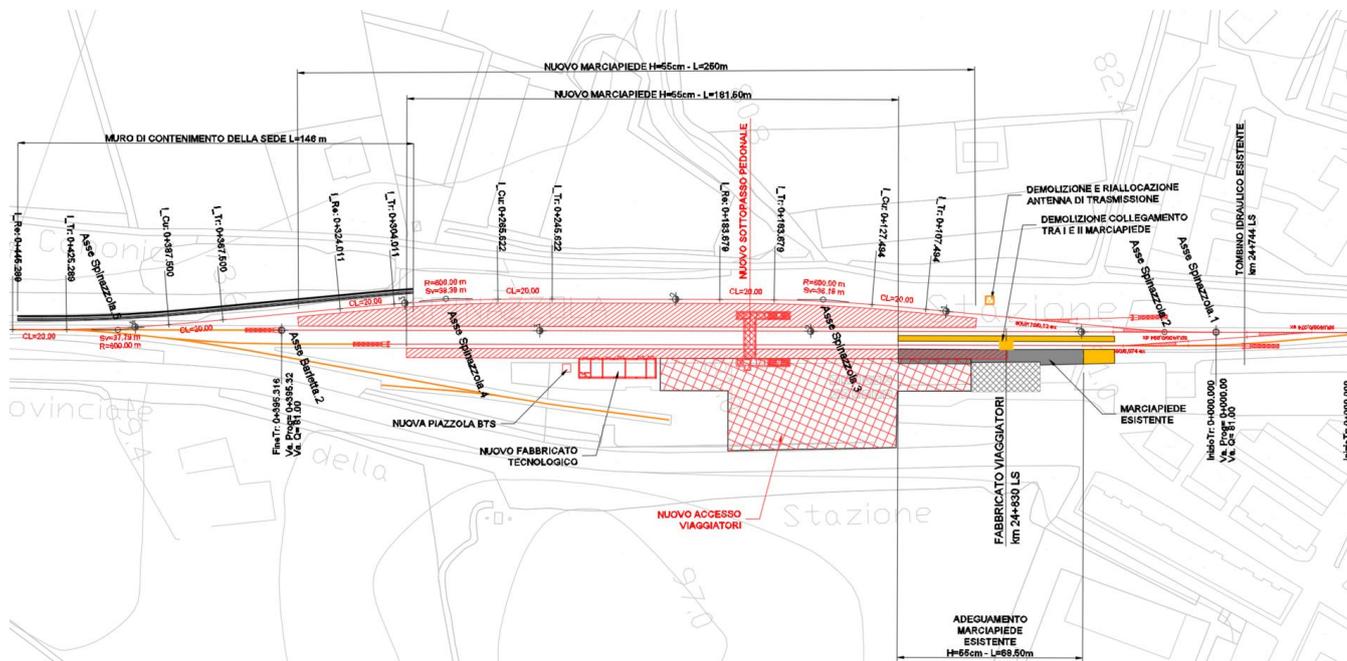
Planimetria di Progetto - Modifica al PRG di Canosa di Puglia
